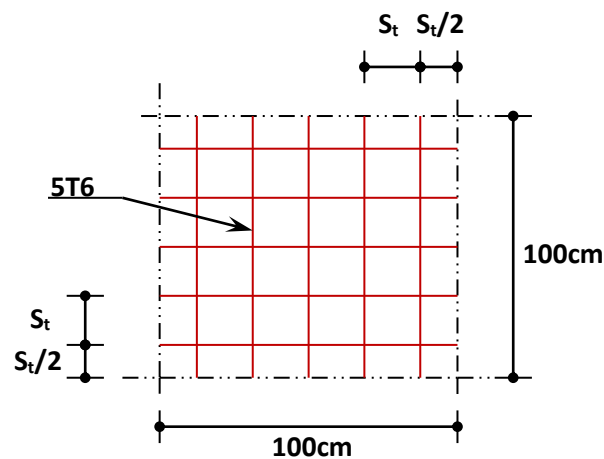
Disposition constructive des armatures de la dalle de compression.
